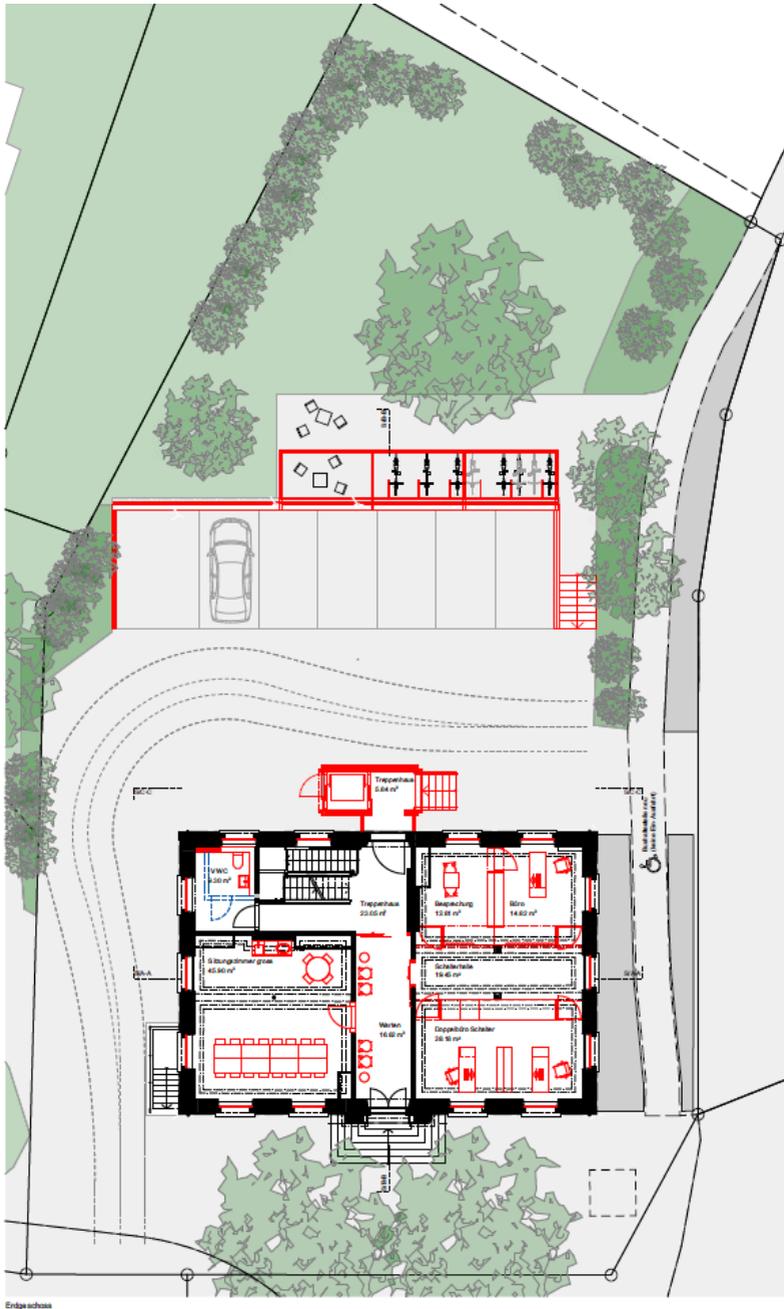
Grundriss Erdgeschoss und Umgebung
